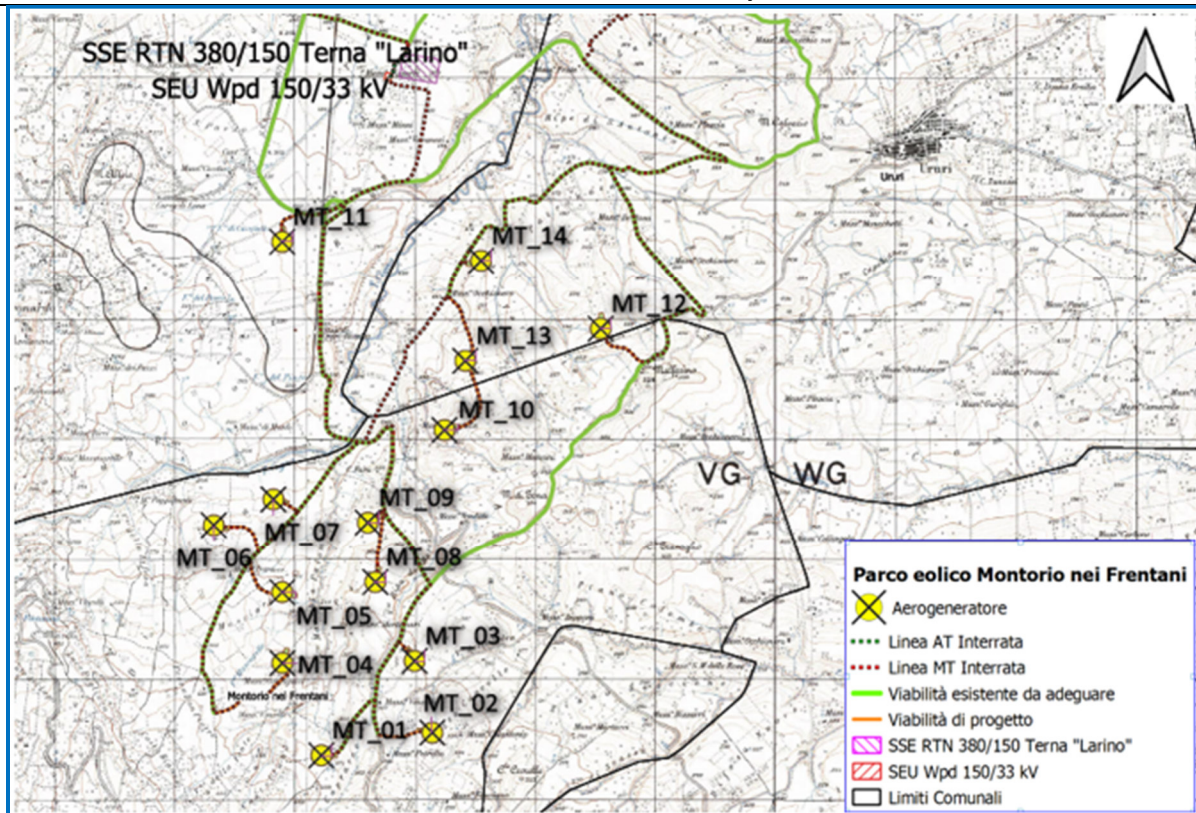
Layout d'impianto: Zona 2 su IgM
